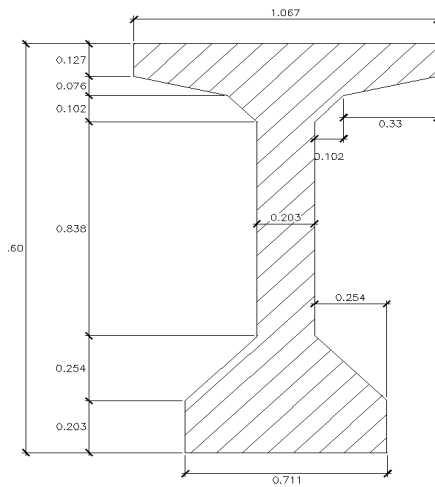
Sección AASHTO tipo V para vigas longitudinales
